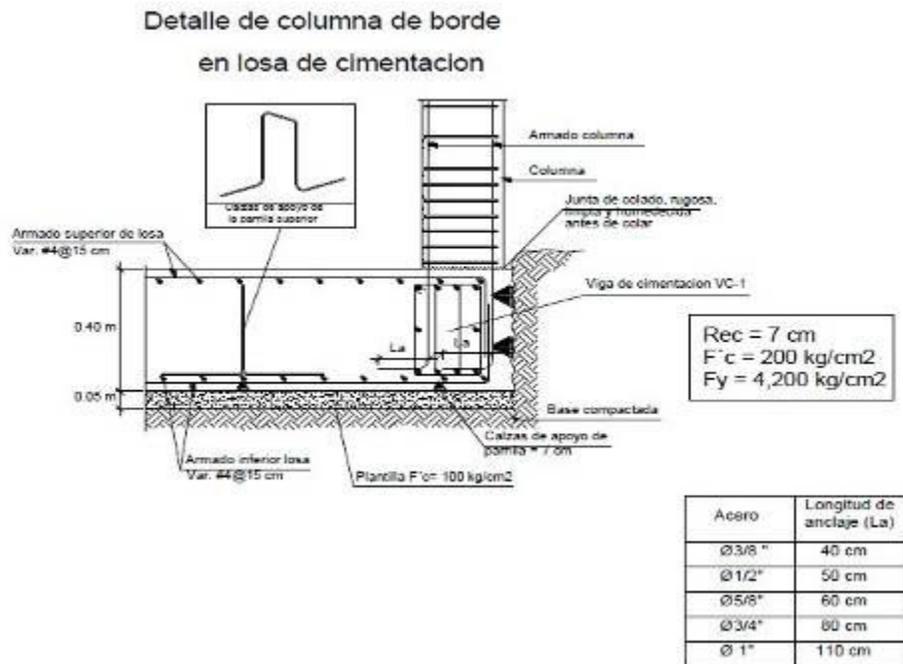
Detalle de columna de borde en la losa de cimentación.
